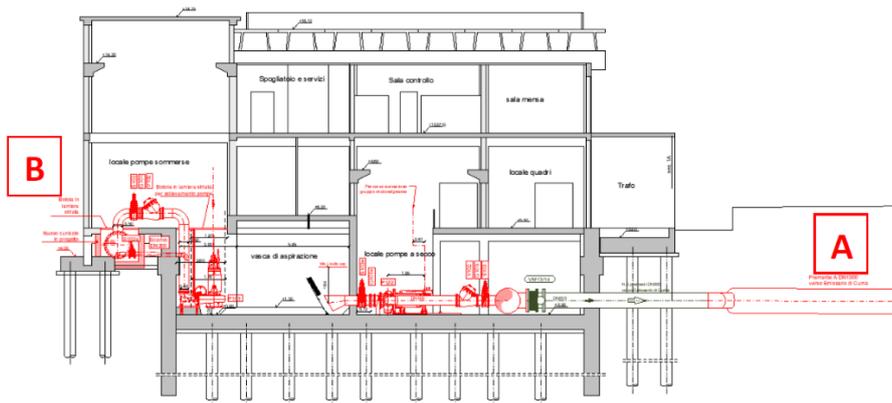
Sollevamenti all'Emissario di Cuma - Sezione A-A - Stato di progetto
